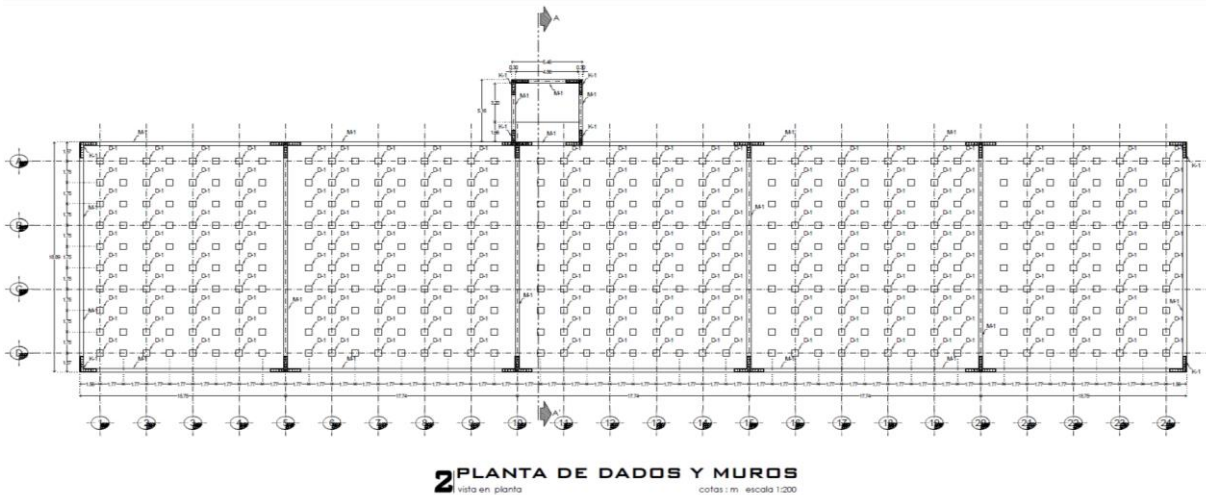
Planta de dados y muros de torre de enfriamiento
